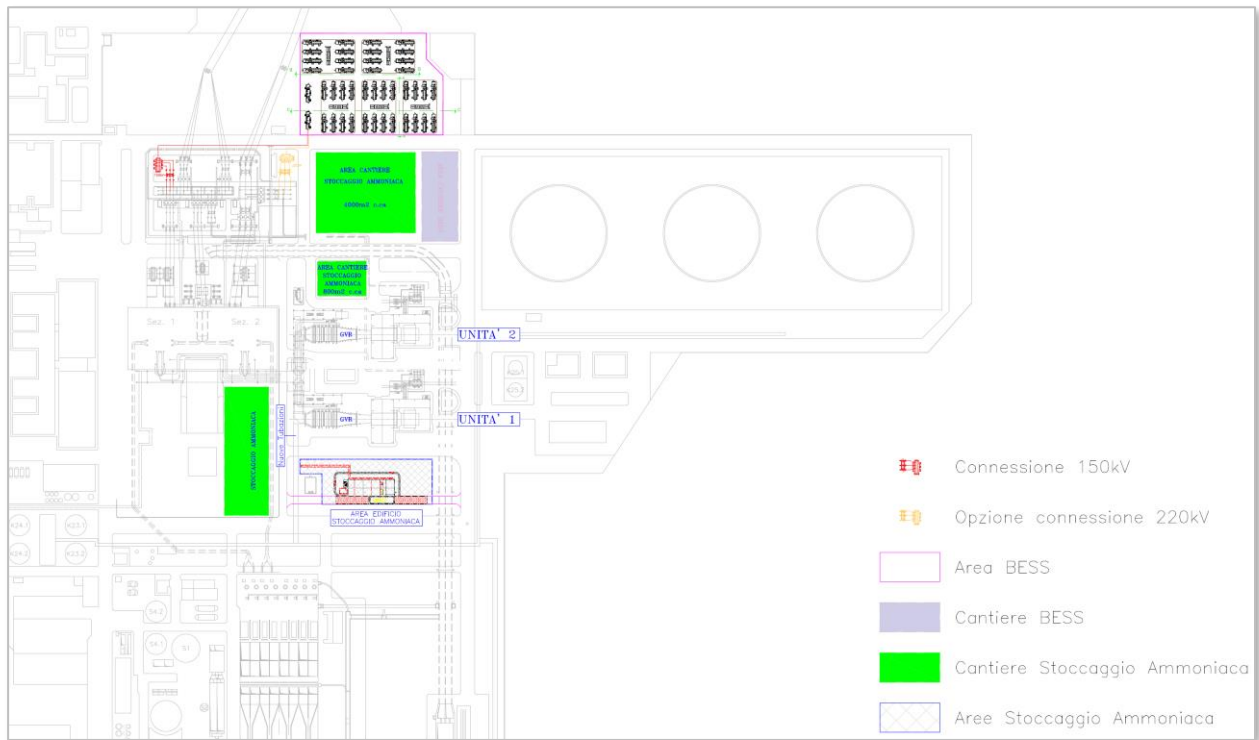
Planimetria generale dell’area di centrale interessata dalla realizzazione del BESS– Stato di progetto
